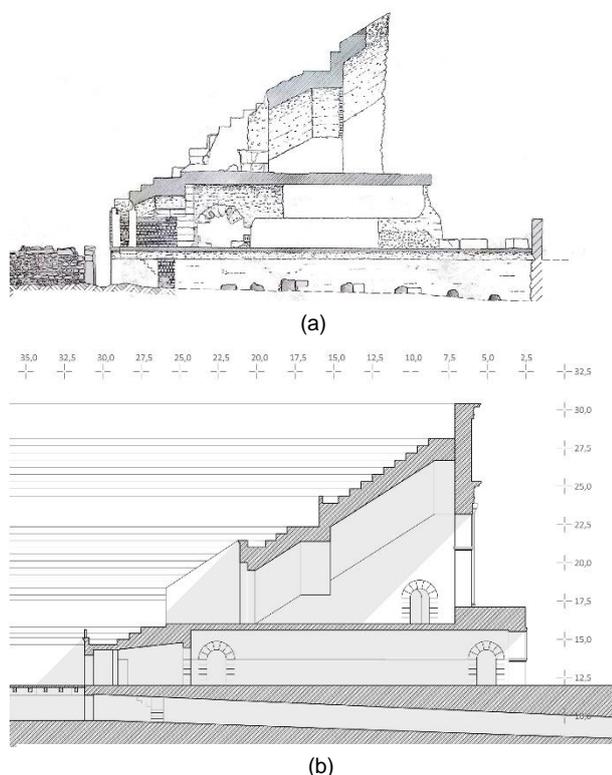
Sección transversal del sector meridional: (a) Sección de los restos conservados; (b) Sección reconstruida.
